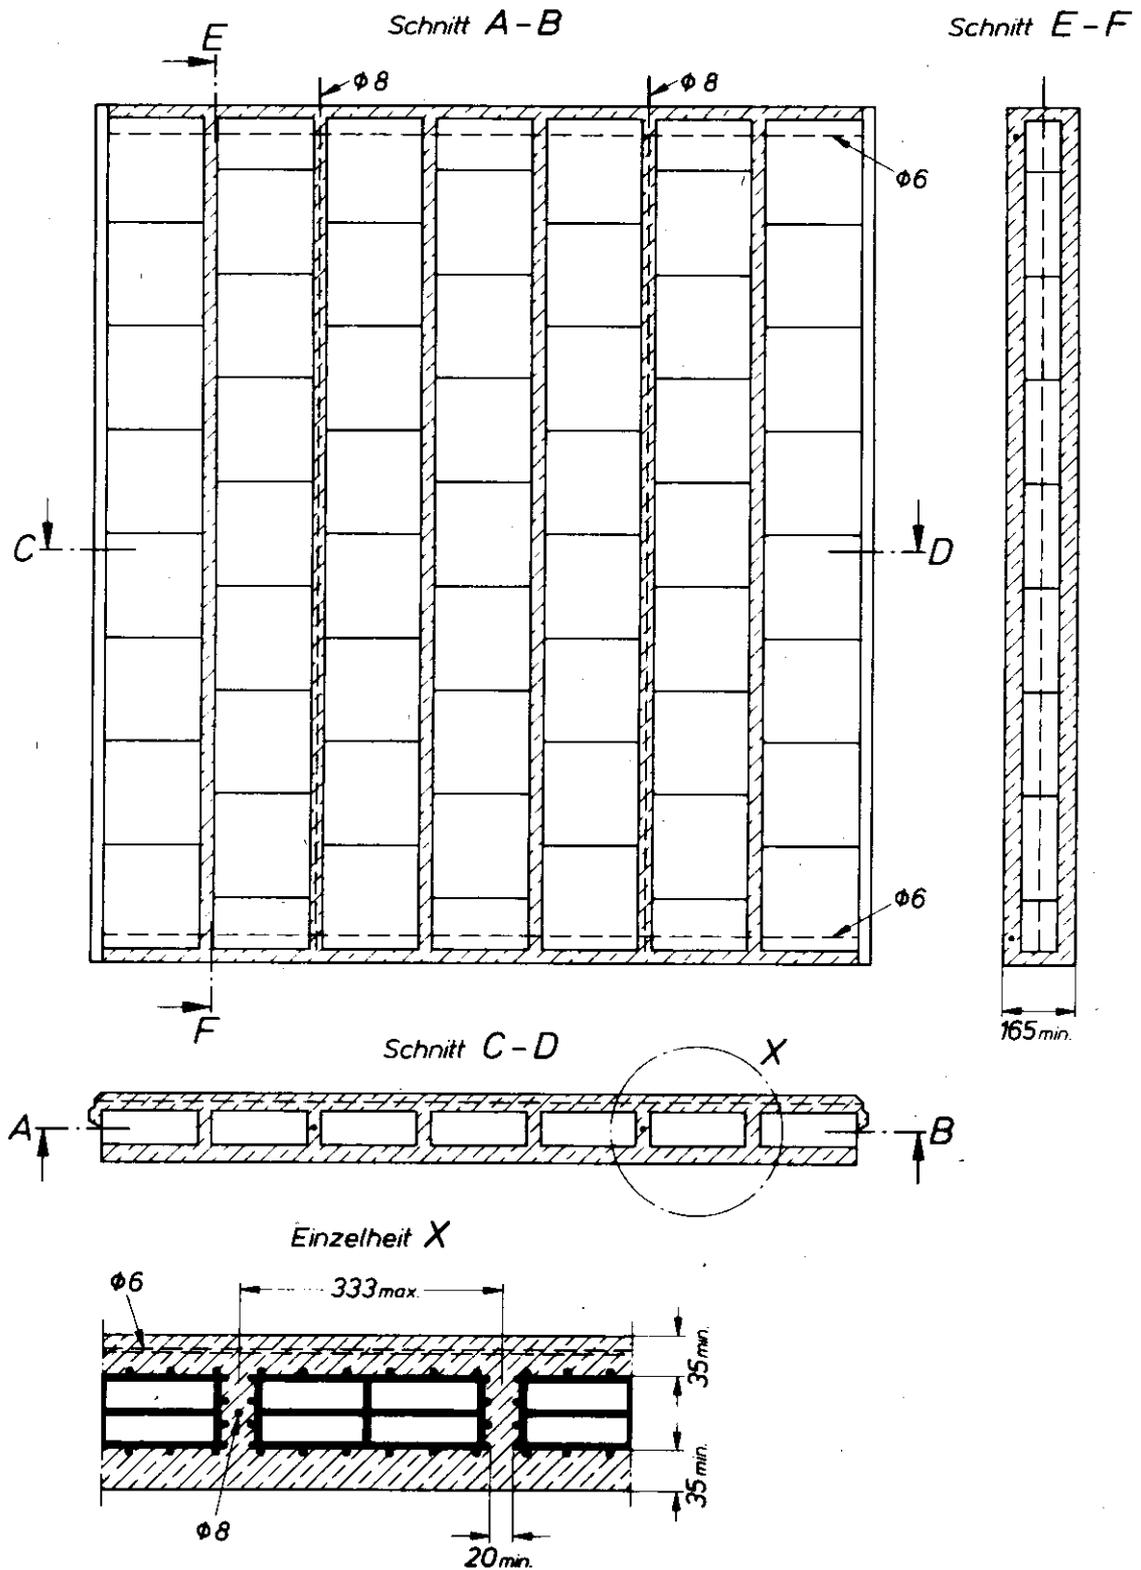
Verbundtafel mit einer Hohl-Ziegelschicht, Mindestbewehrung
